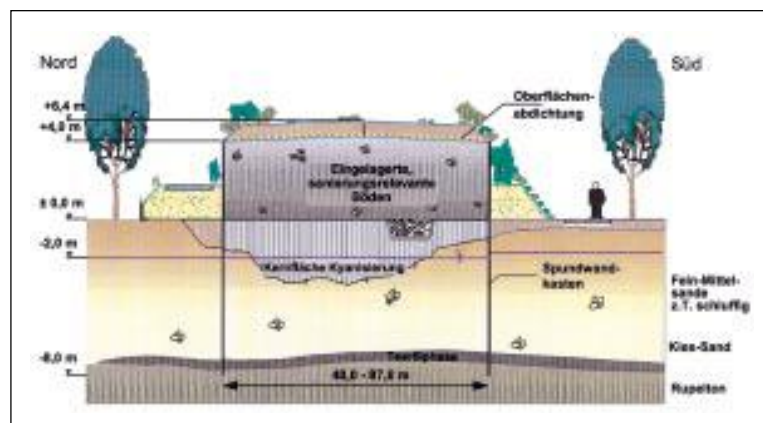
Prinzipskizze Sanierungsbauwerk (Schnitt)
